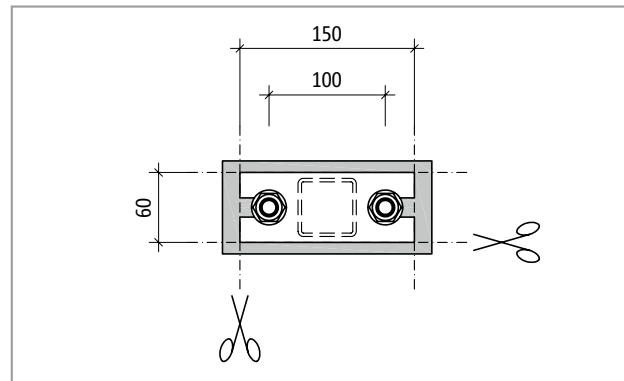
Schöck Isokorb® T type S-V: Dimensions according to cutting of insulating element
